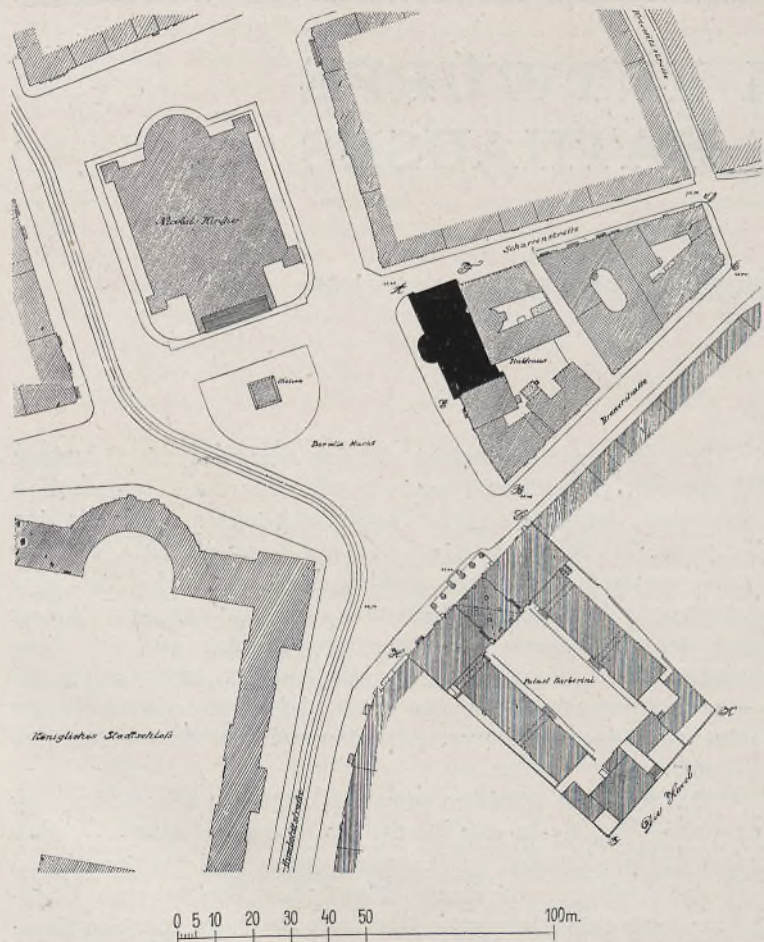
Lageplan des Alten Marktes in Potsdam.
